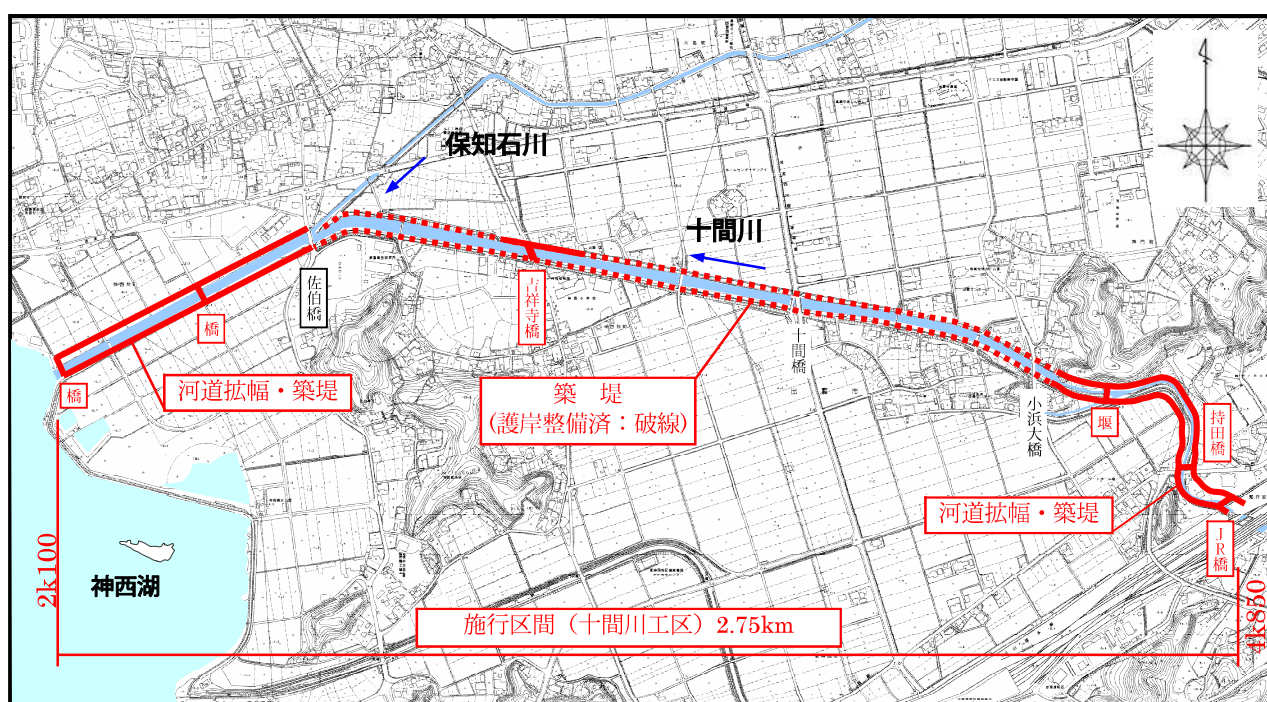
平面図（十間川工区）(S=1/15,000)
